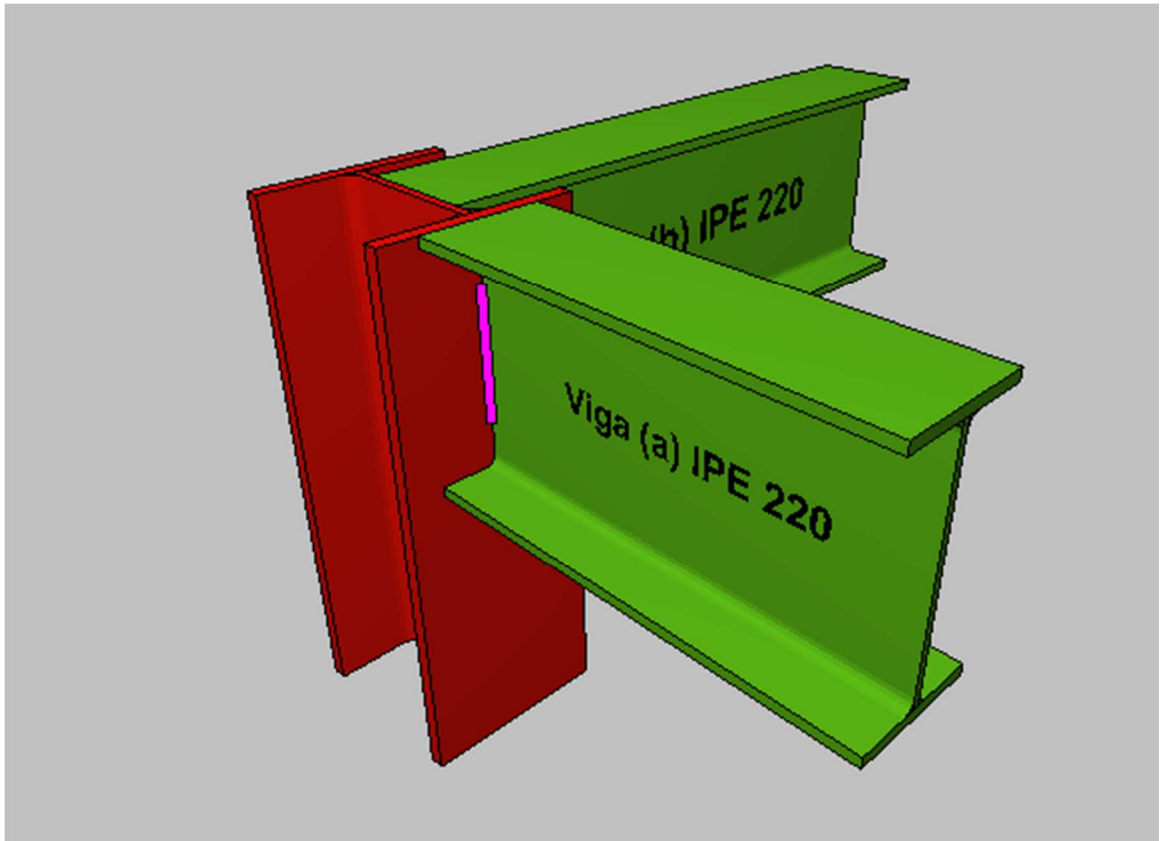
Unión tipo 2 soporte superior. Viga-pilar-viga
